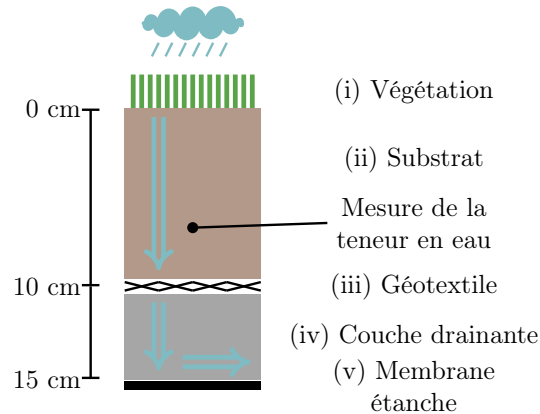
Schéma d'une vue en coupe d'une toiture végétalisée
